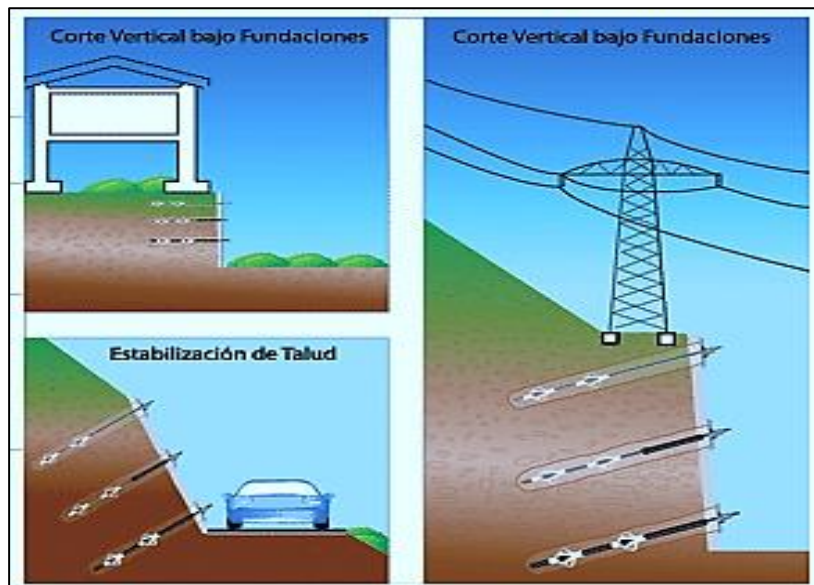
Aplicaciones del Sistema Soil Nailing.
